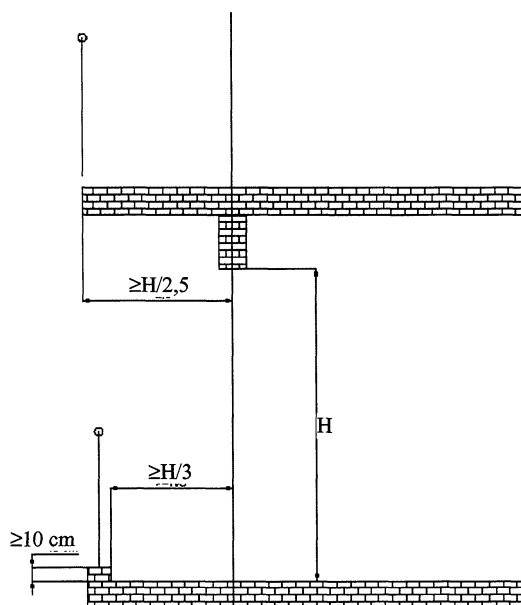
Ilustração do comprimento de palas ou varandas
